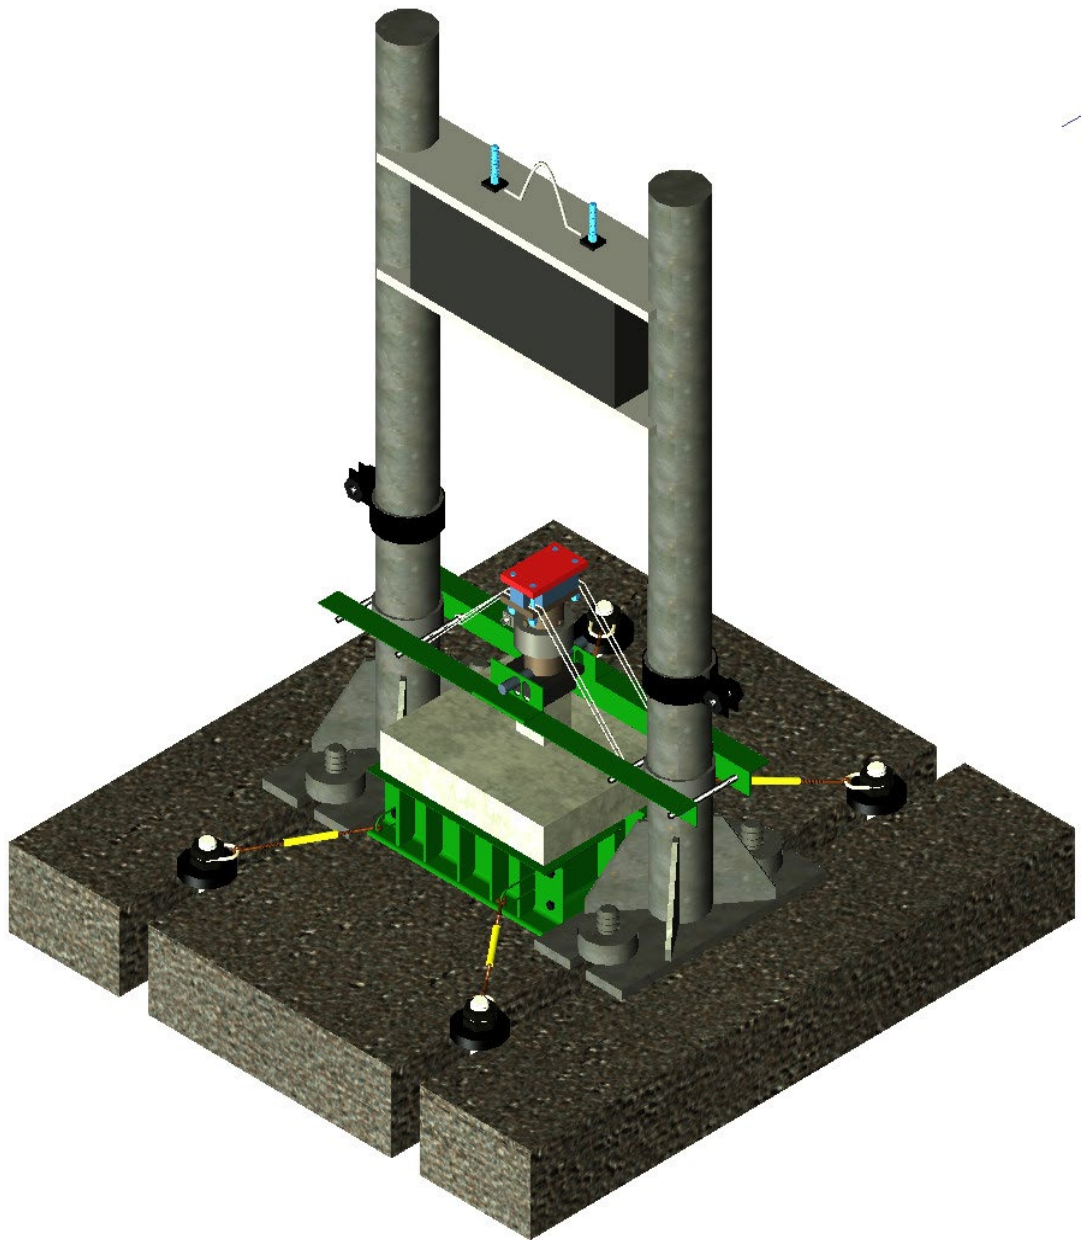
Стенд для проведения испытаний железобетонных элементов при работе на продавливание при кратковременном динамическом нагружении. Трехмерная модель
